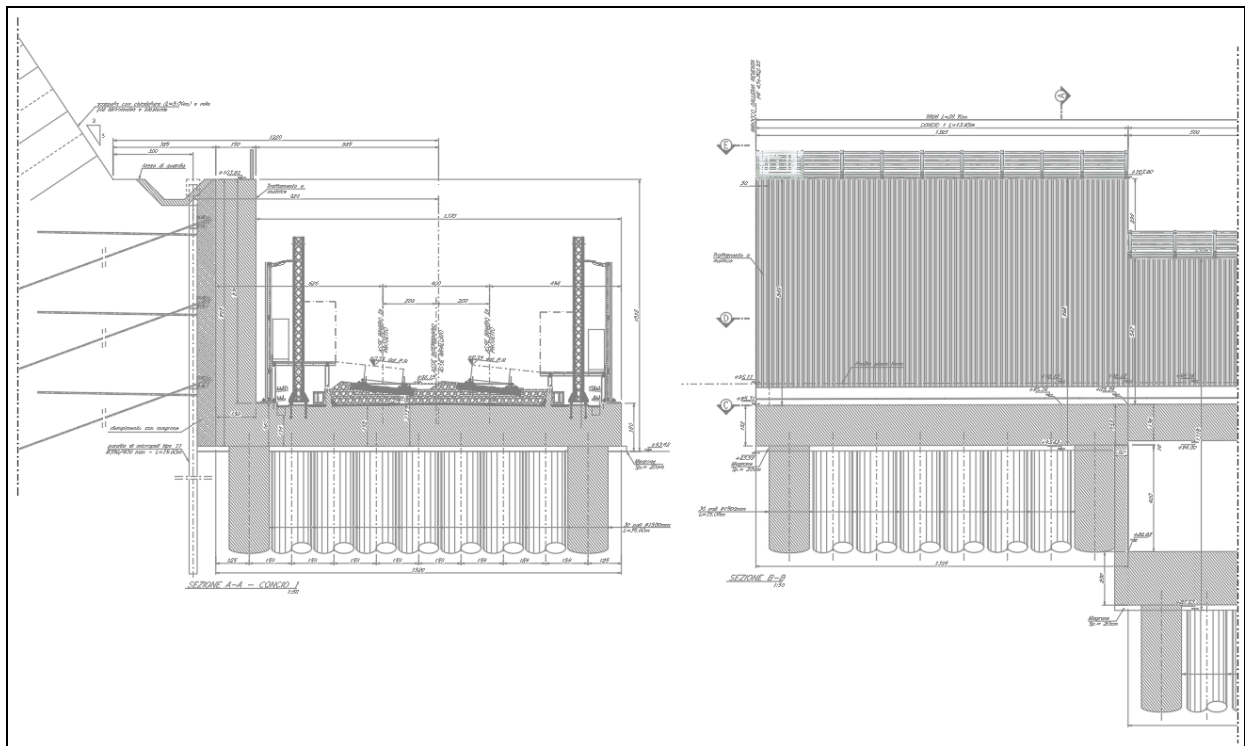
Sezione e prospettiva Concio 1\_TR26
